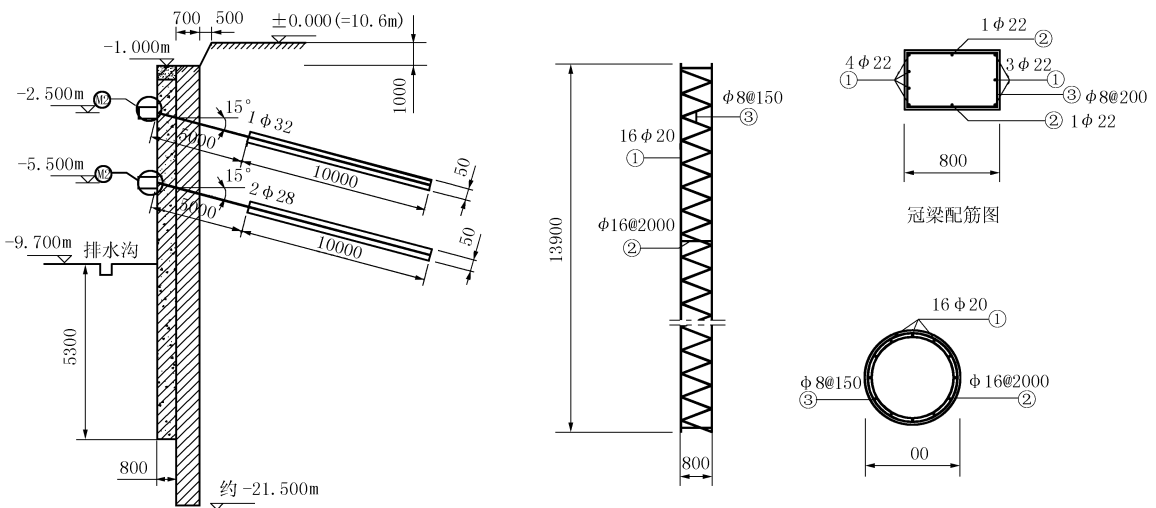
钢筋混凝土桩 + 锚杆支护剖面图
